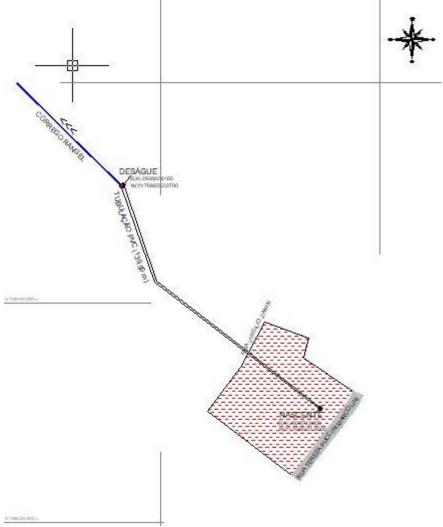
Planta planimétrica da área da tubulação a ser instalada.
